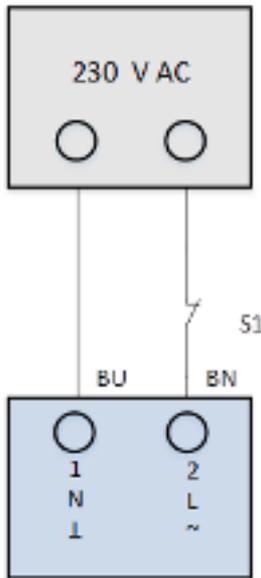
1-Draht-Steuerung Federrücklaufantrieb
